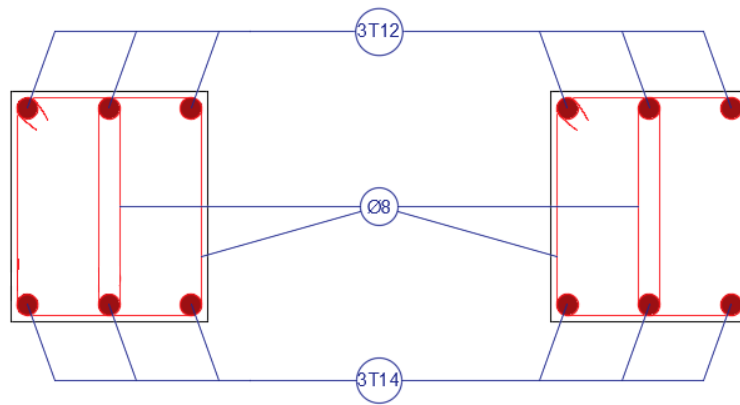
Ferrailage d'une coupe en travée et en appui de la poutre palière
